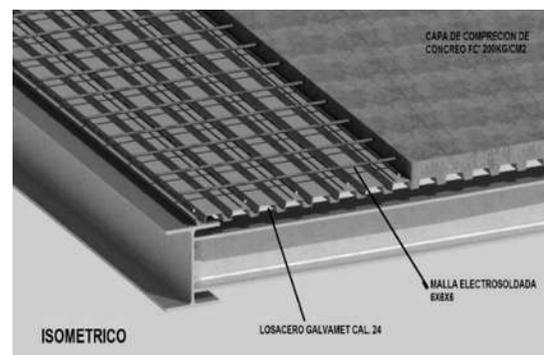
Esquema de losa cero. Fuente: Elaboración propia
